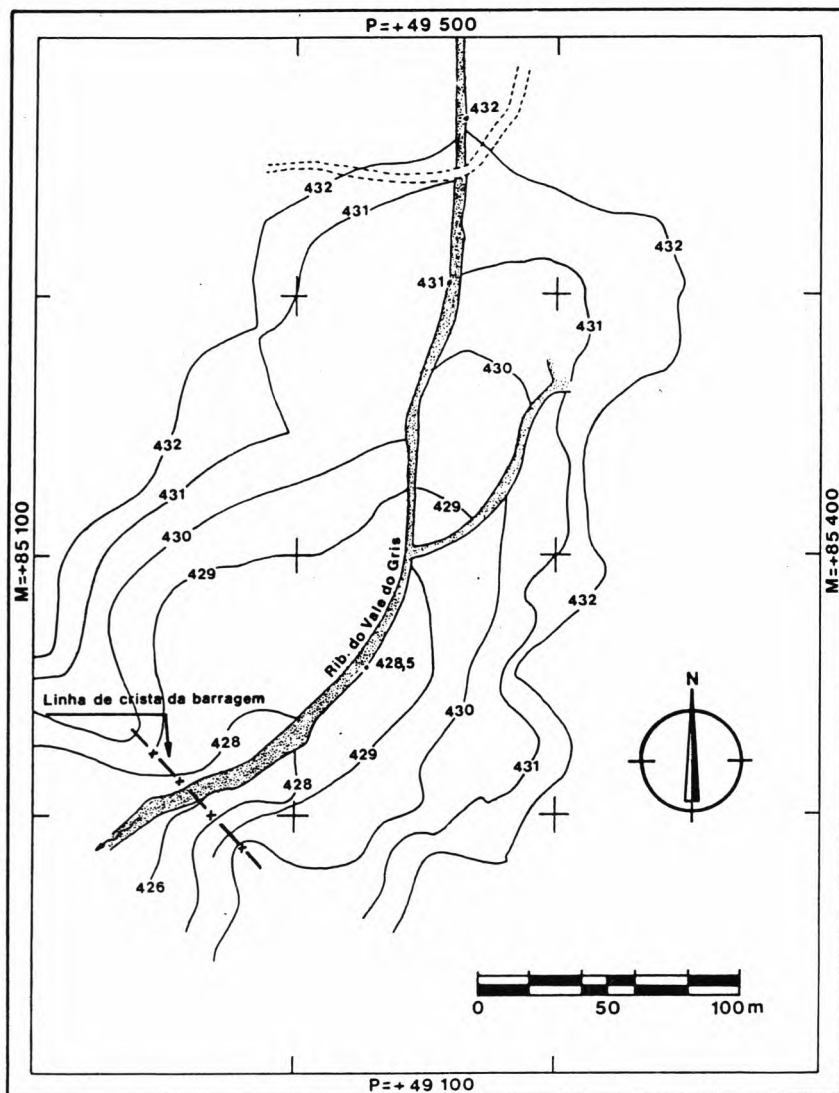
Barragem da Lajinha (Penamacor). Planta da albufeira
